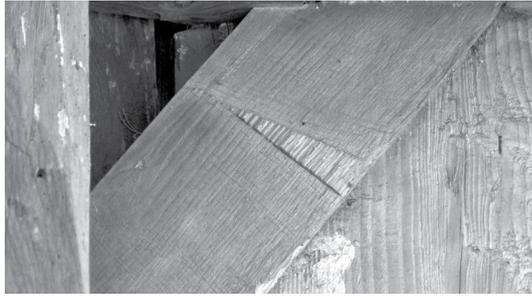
Sägespuren mit dreieckigen Spaltflächen.
